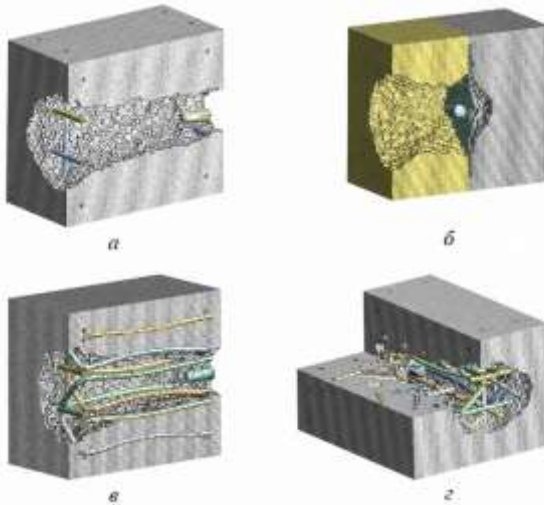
Характер проникнення ударника в дослідні залізобетонні плити з різними типами армування: а — подвійна сітка; б — суцільний металевий лист; в — подвійна сітка з поперечною арматурою; г — комбіноване армування з поперечною арматурою, подвійною сіткою та фіброю [4]
